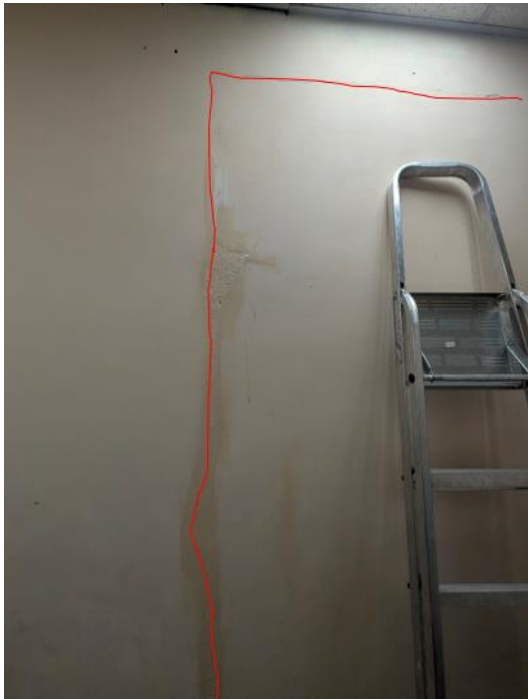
Трещина по штукатурке в заложенном проёме коридора, помещение по плану №31, 3 этажа помещения 8-Н
